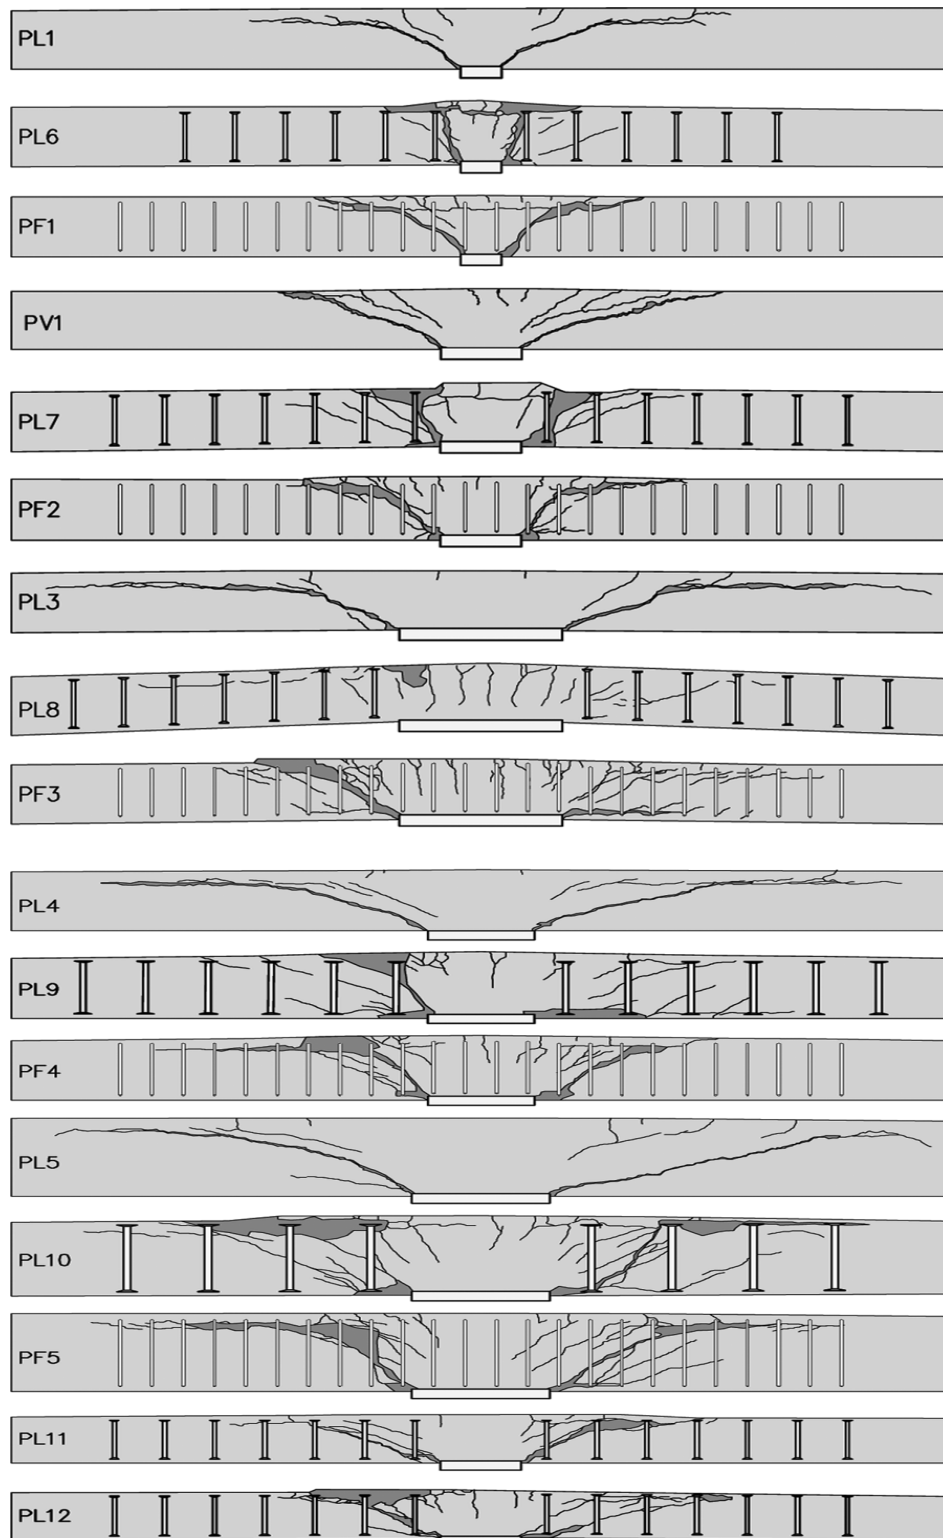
Padrão de fissuração após o ensaio [6]
